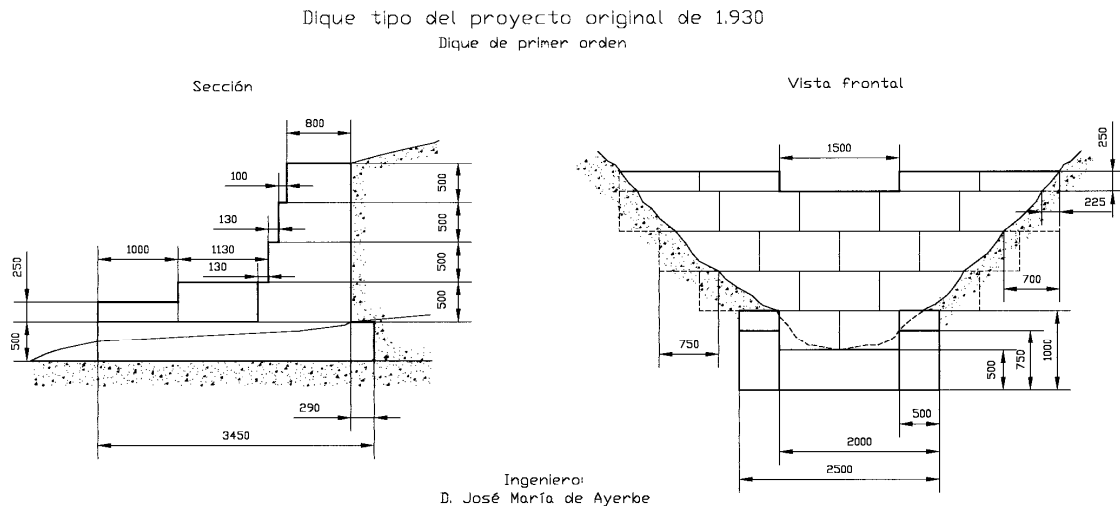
Alzado y perfil del dique tipo de la restauración de 1930. (Ayerbe, 1930).
